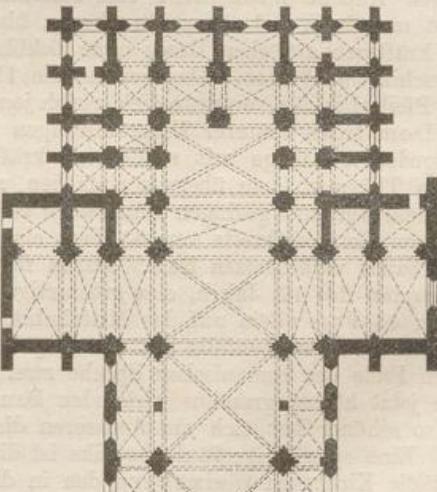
Grundriss von Ebrach. (Nach v. Quast.)
